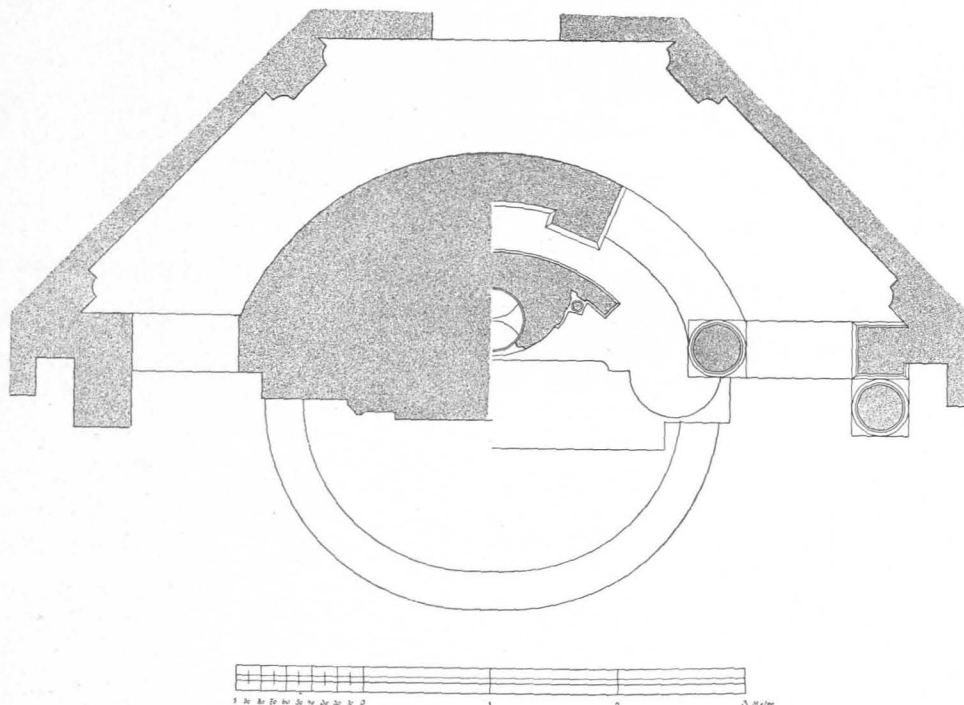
Köstendorf, Pfarrkirche, Grundriß des Hochaltars 1 : 60 (S. 90)
